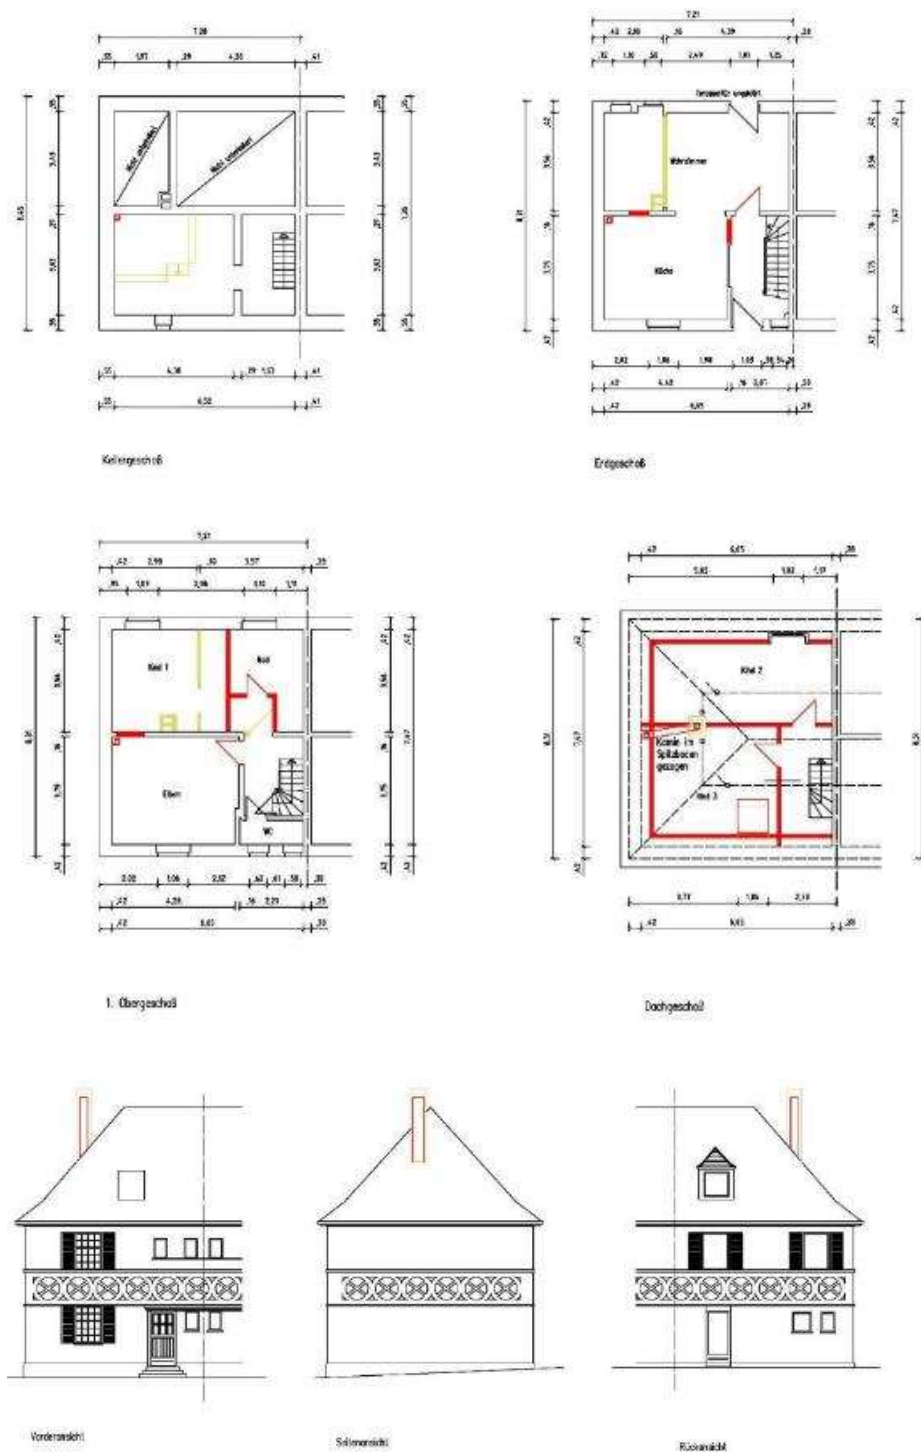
Vorplanung bzgl. Grundrissänderung (gelb = Abriss, rot = Neu)
